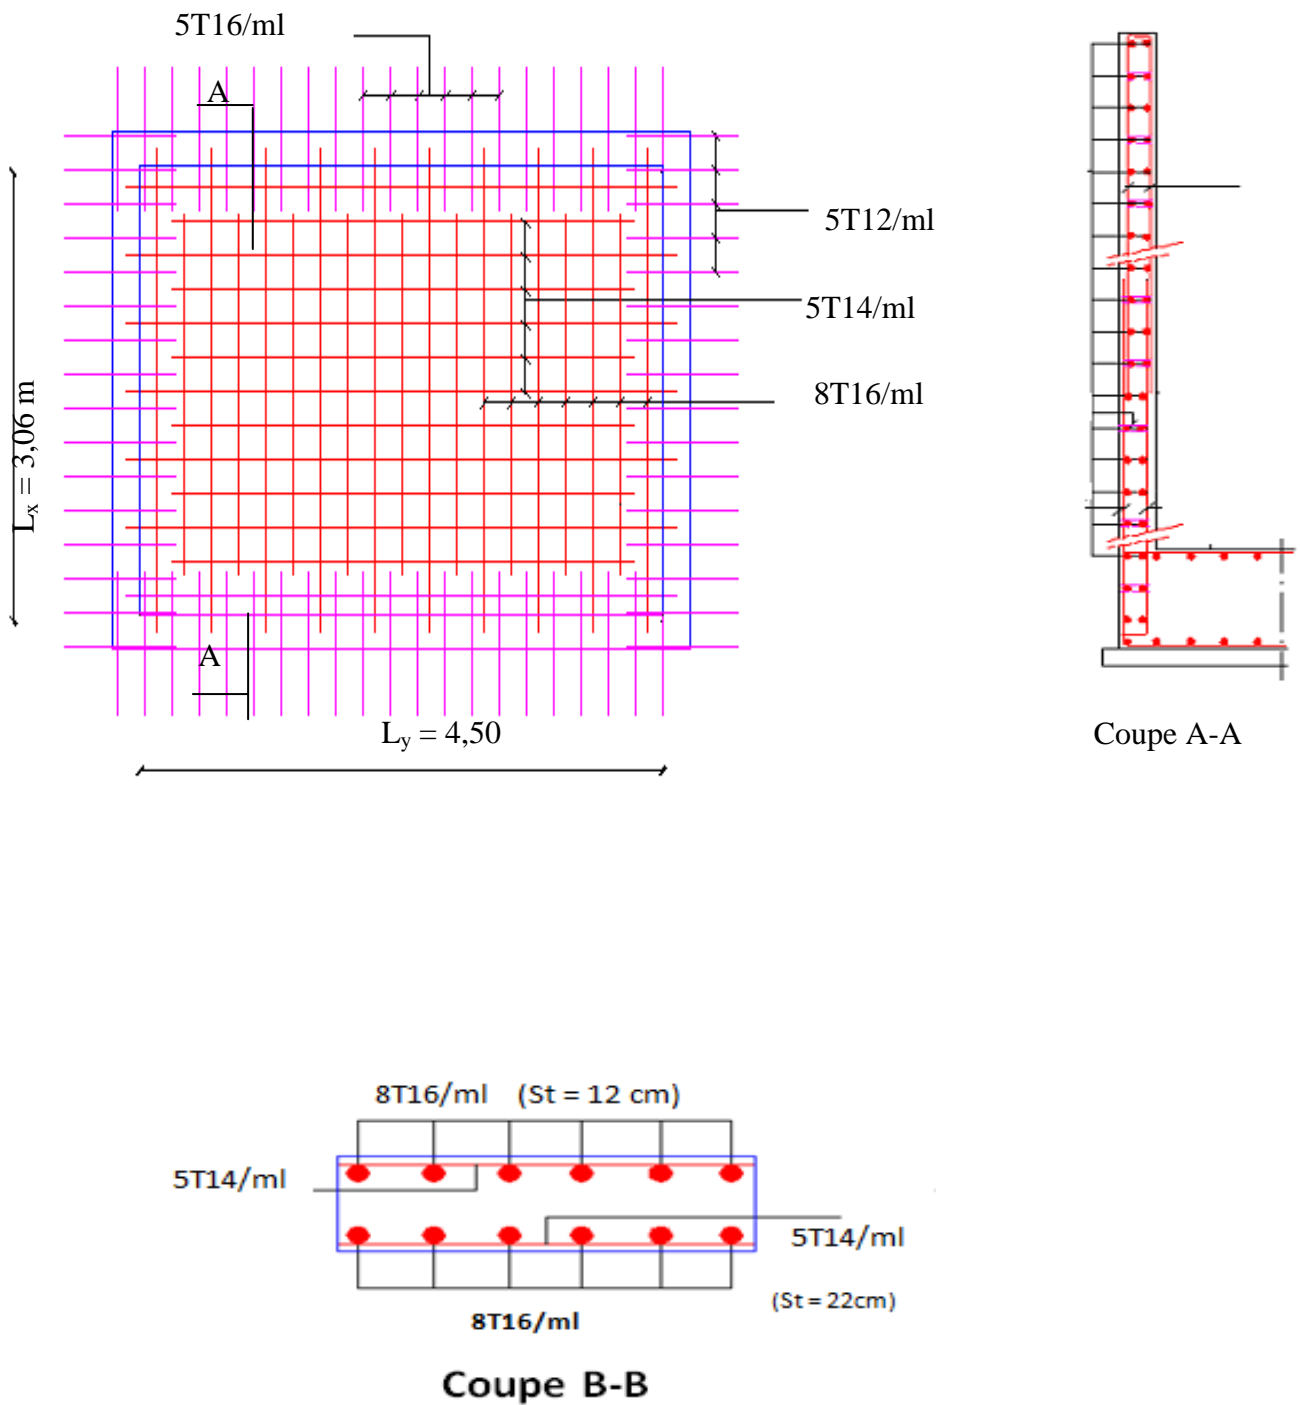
Schéma de ferrailage du voile Périphérique.
